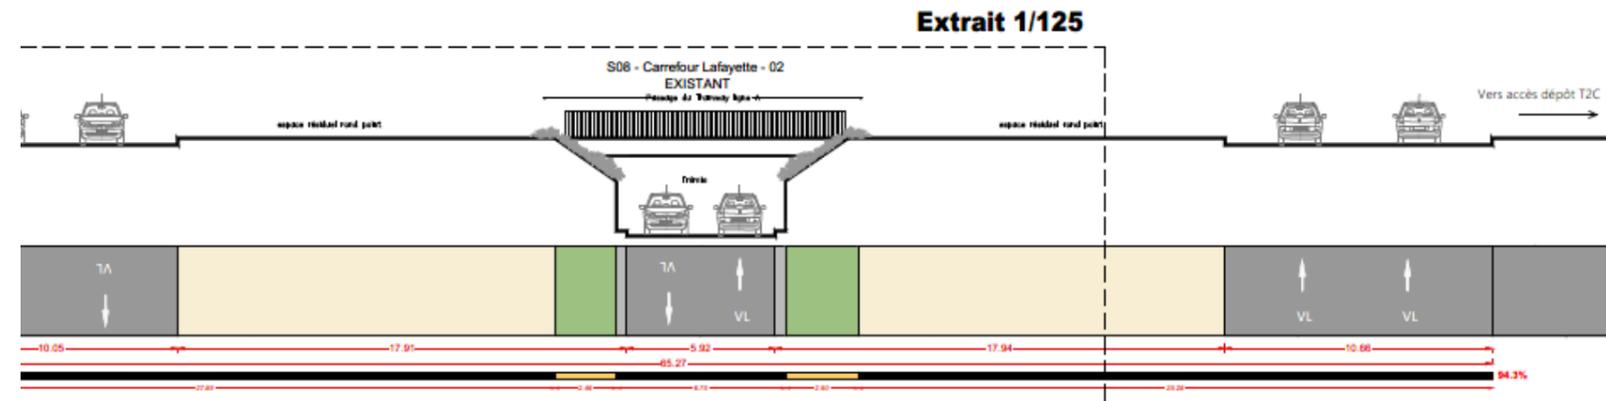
Profil existant sur le boulevard Schuman au droit du carrefour avec le boulevard Lafayette
